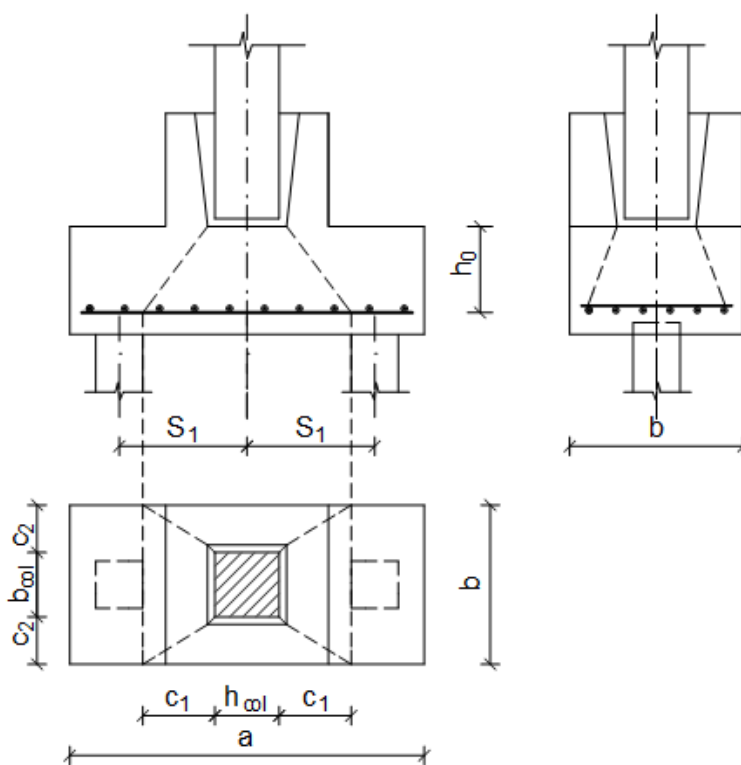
Схема утворення піраміди продавлювання під збірною залізобетонною колоною у двопальовому фундаменті
